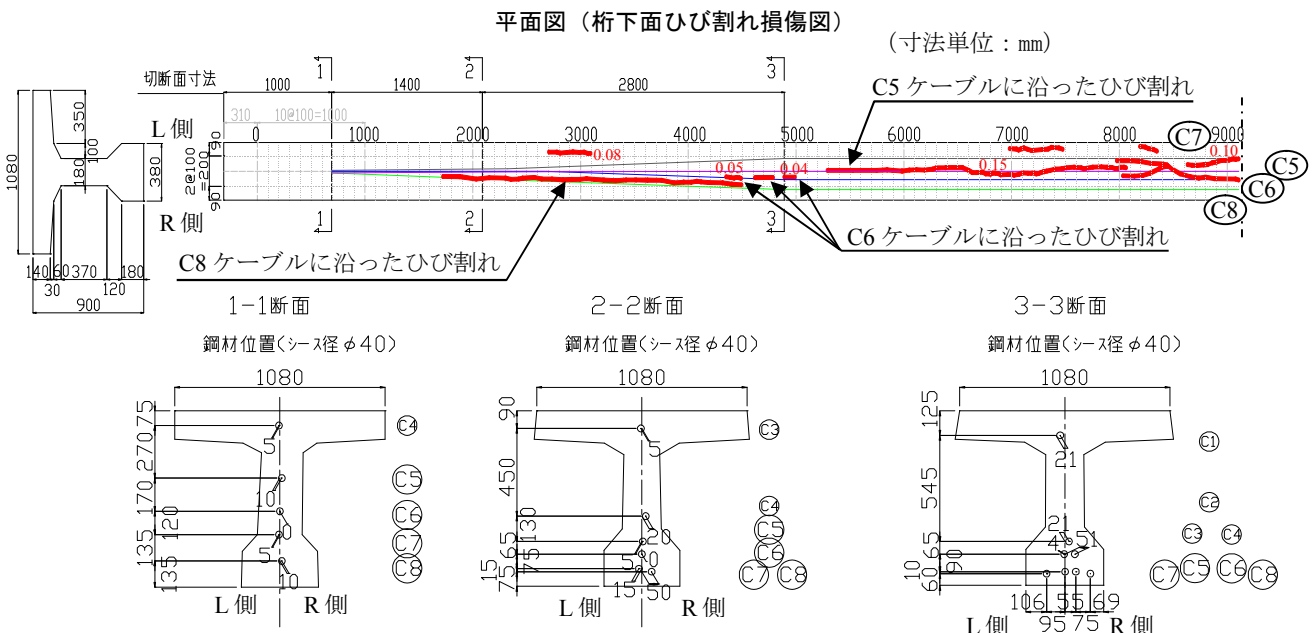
桁下面ひび割れ損傷とシース配置位置 (A1側)
